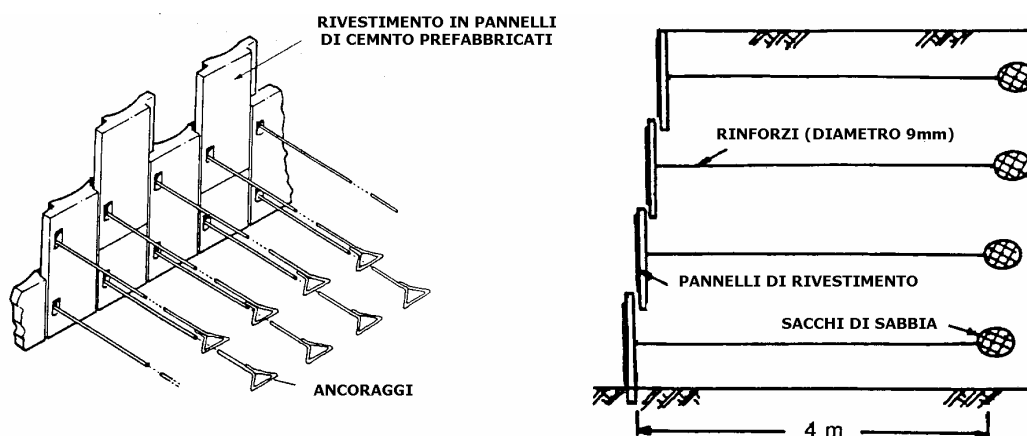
Rappresentazioni schematiche di terre ancorate. A sinistra, elementi di ancoraggio ottenuti piegando l'estremità inferiore delle barre a triangolo (da MURRAY & IRWIN, 1981; modificato). A destra, ancoraggi realizzati tramite sacchi di sabbia conosciuti con gli elementi di rinforzo; le barre e gli ancoraggi sono posizionati nel rilevato durante la costruzione (da FUKUOKA, 1986; modificato) -
